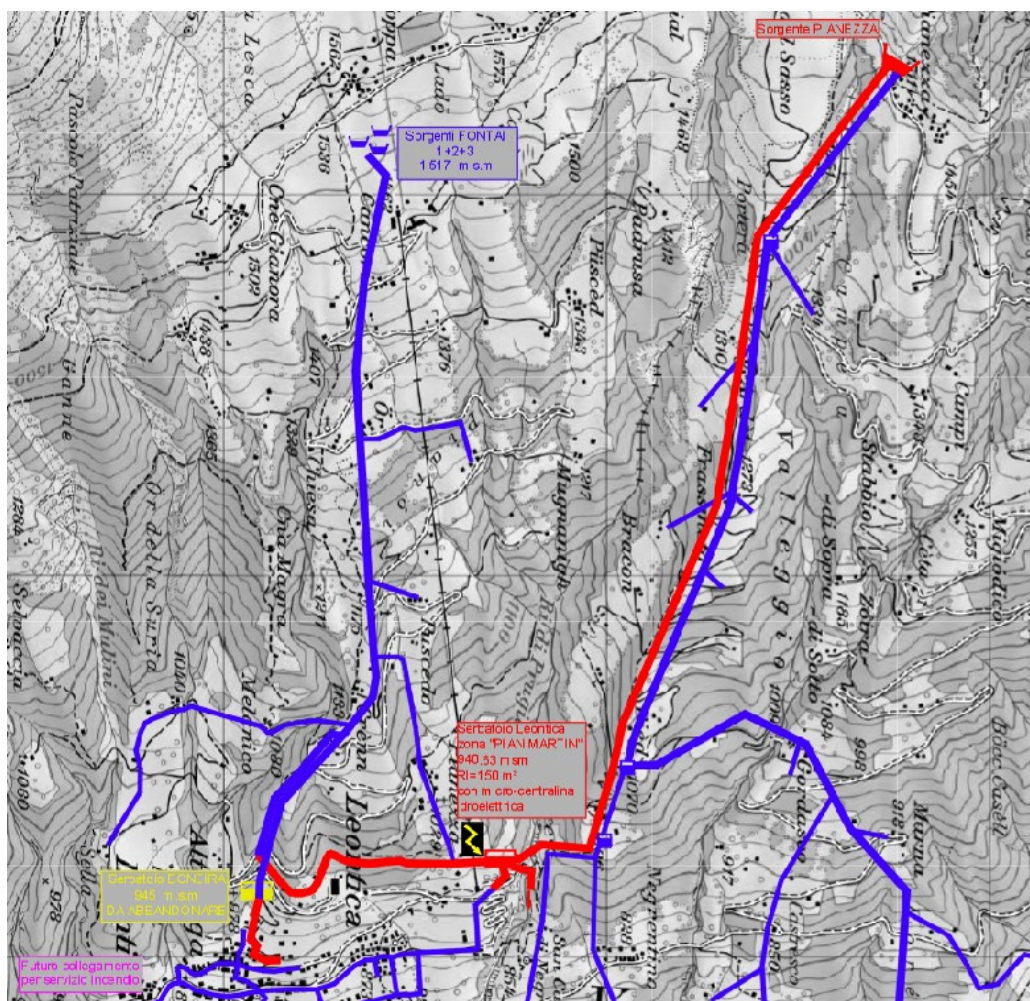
Planimetria generale nuova condotta "Pianezza" – Leontica (in rosso sono indicati gli interventi)
